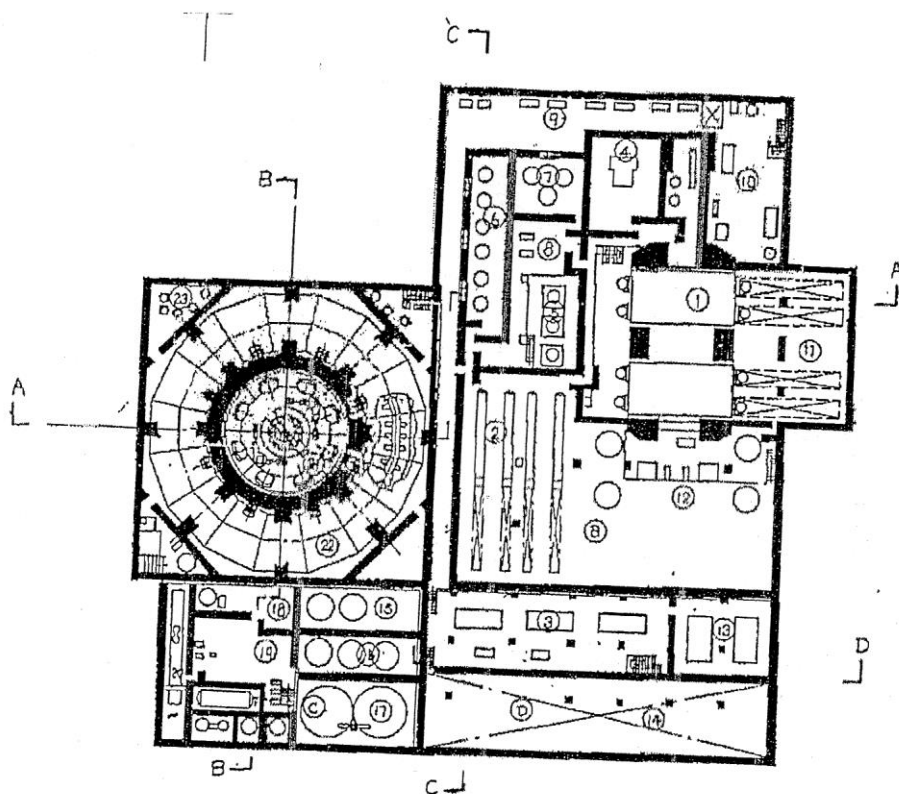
1号機タワービル建屋地下1階・1階配置図
